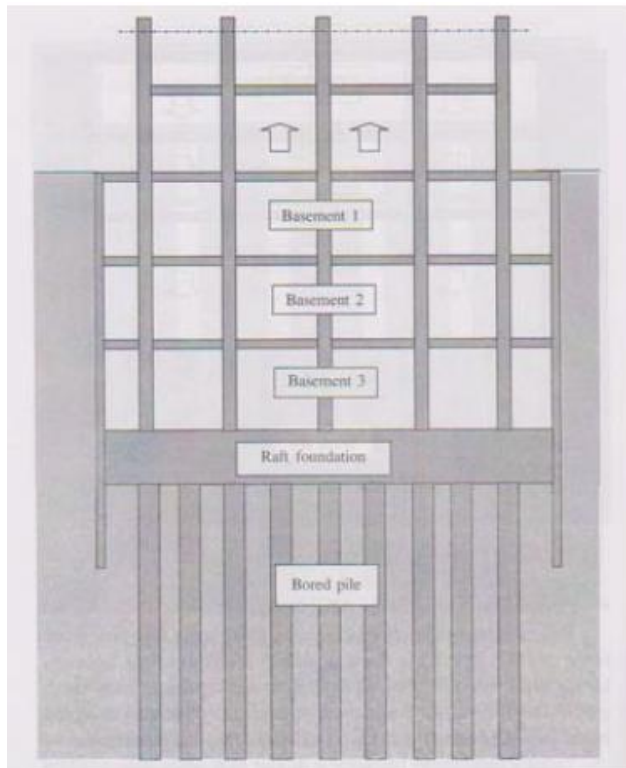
Pengecoran lantai basemen 1, 2, dan 3
